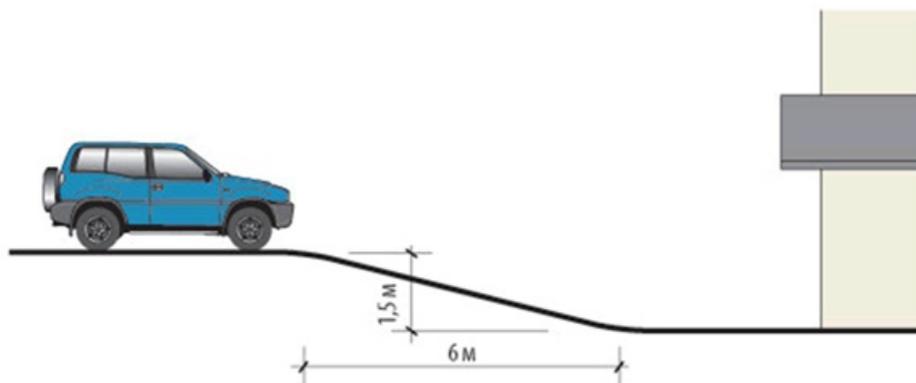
Схема пандуса для подъезда к закругленному гаражу
